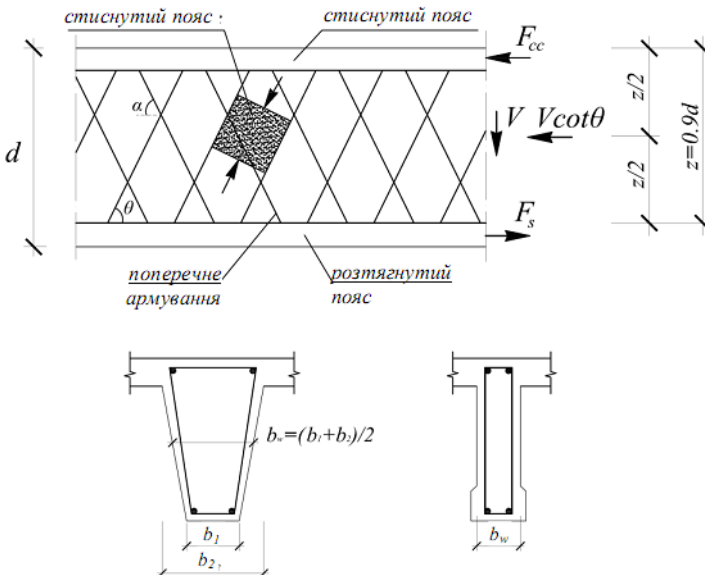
До розрахунку міцності залізобетонних елементів при дії поперечної сили за методом фермової аналогії згідно з [2]:
